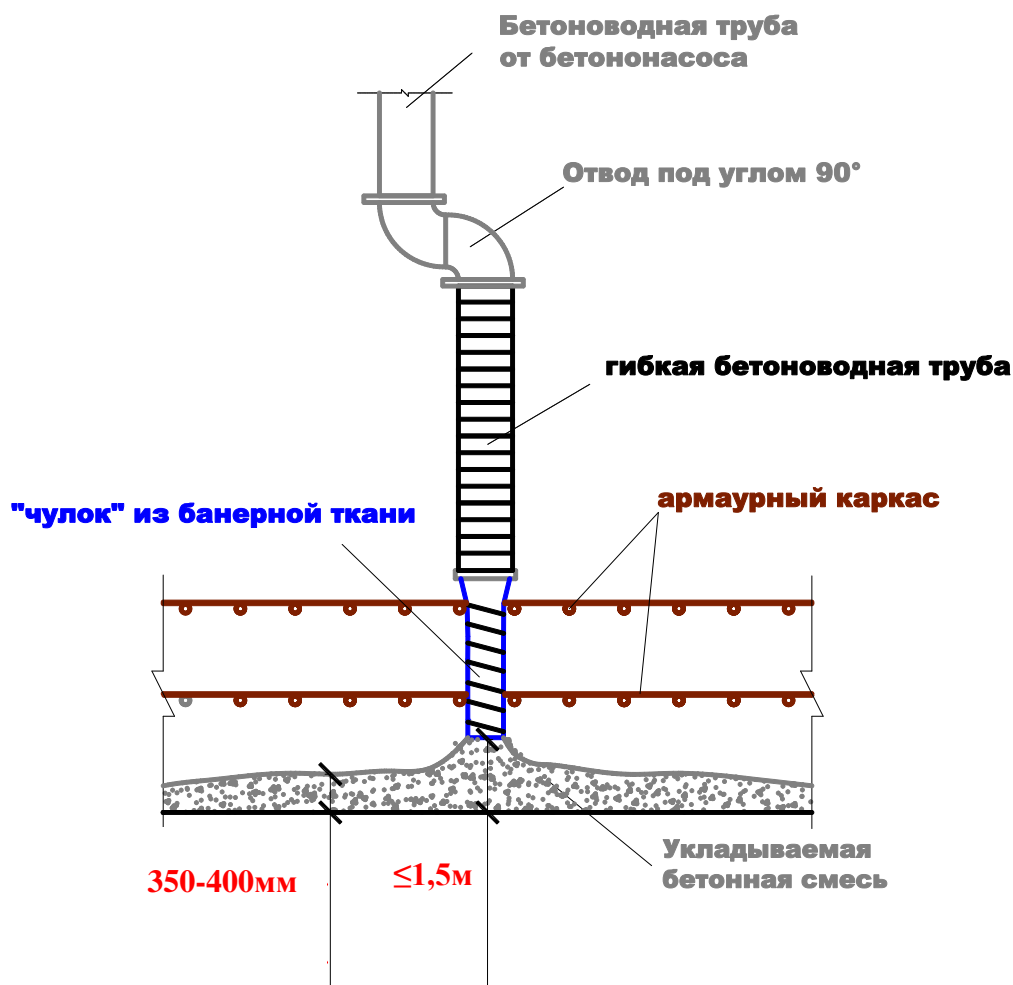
Схема подачи бетонной смеси в блок по бетоноводу с установленным отводом – коленом под углом 90° и «чулком» из банерной ткани.
